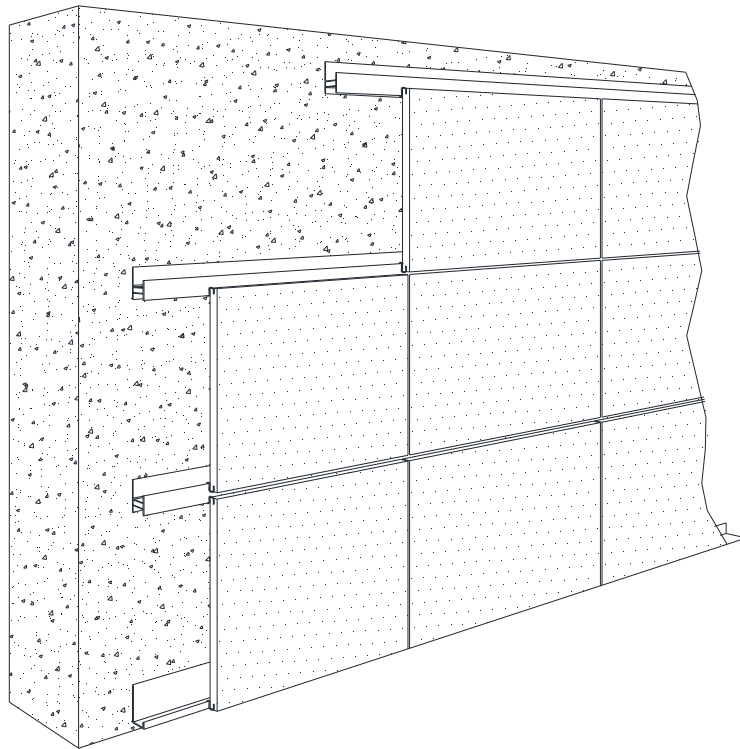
Principe de montage coupe verticale (joint horizontal) fixation visible
